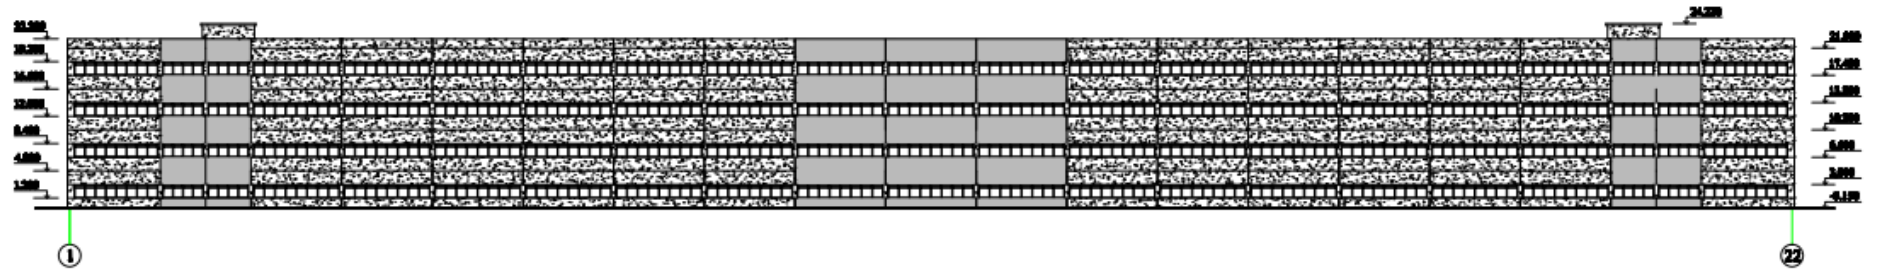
Фасад будівлі у вісях 1 - 22
